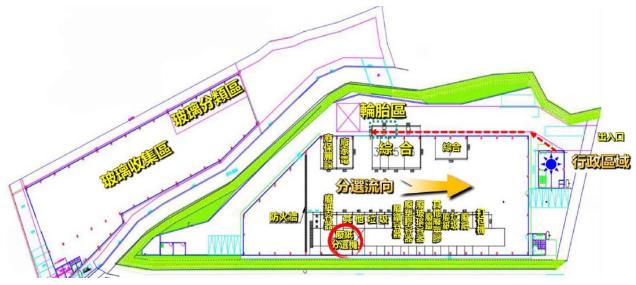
桃園市南區細分類廠平面配置示意圖
